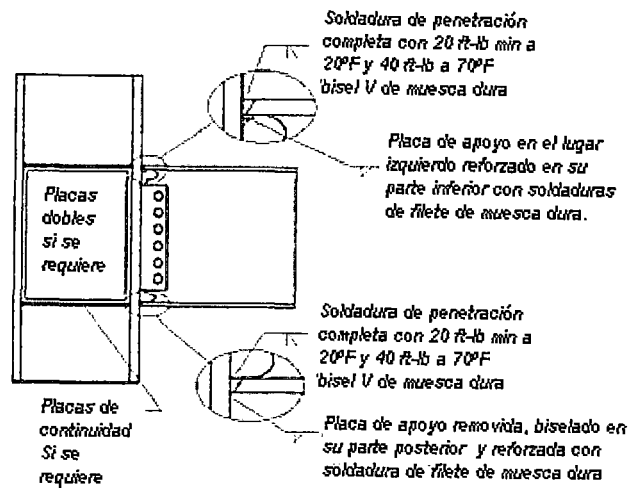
Mejoras en el proceso de soldadura (FEMA 355D, 2000)
